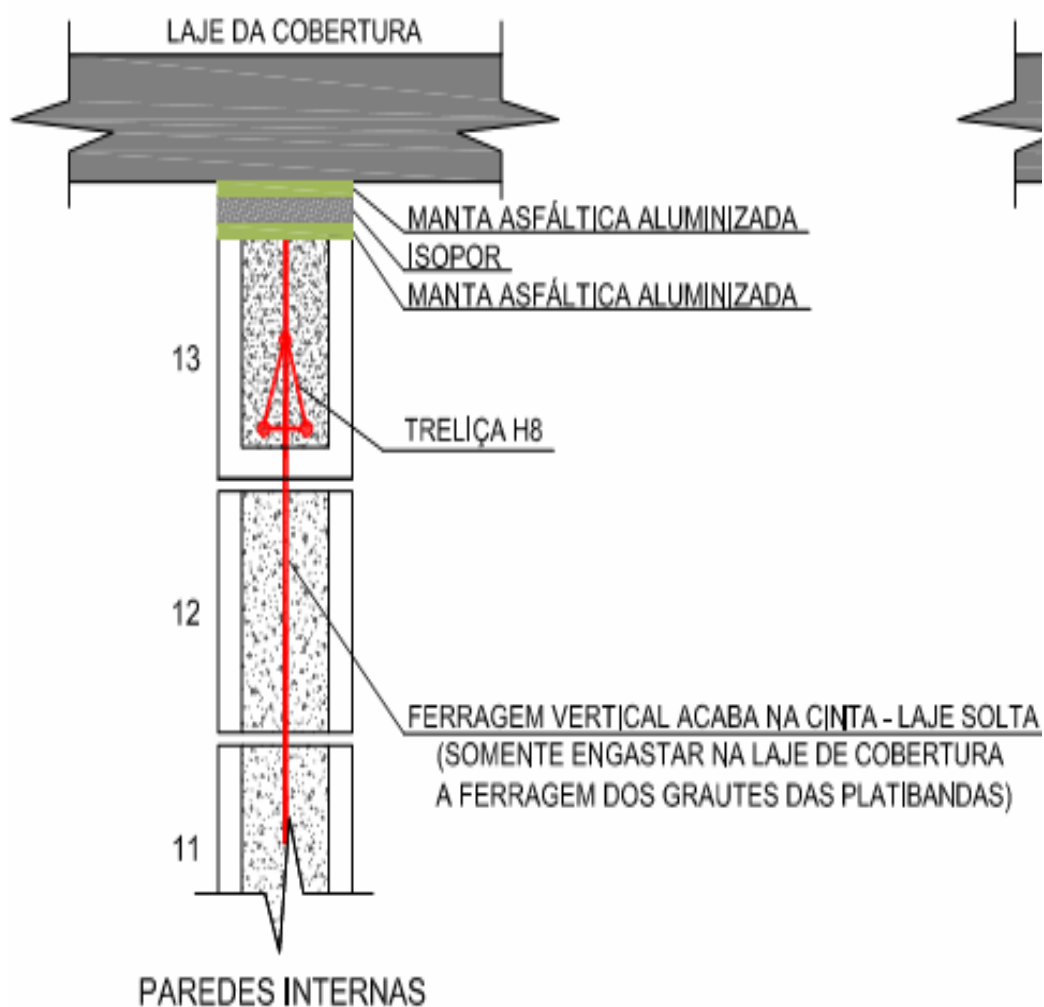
detalhe do apoio das lajes maciças em paredes internas
